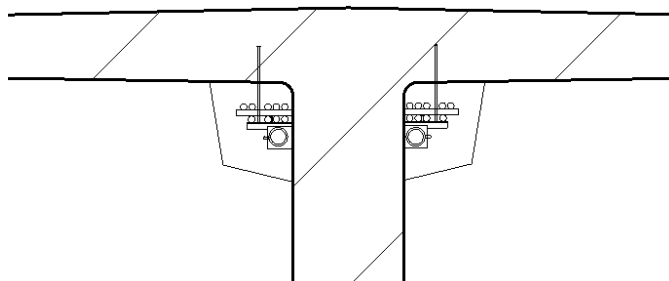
Схема предварительного напряжения железобетонных плит надпорного участка пролетного строения пучками из высокопрочной проволоки, выполненная в AutoCAD
